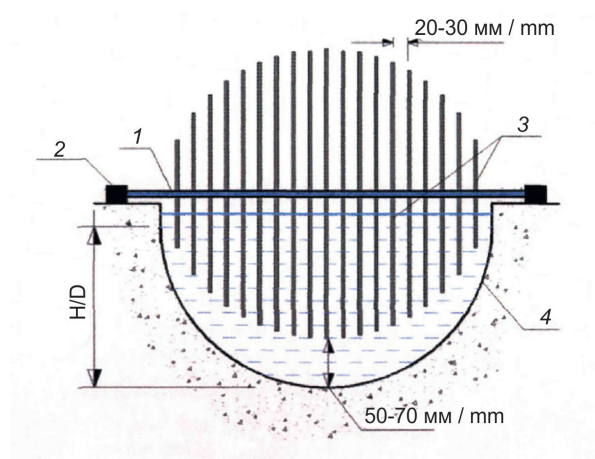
Самовращающийся аэратор: 1 — вал; 2 — подшипники на опорах; 3 — круглые диски; 4 — лоток трубы
